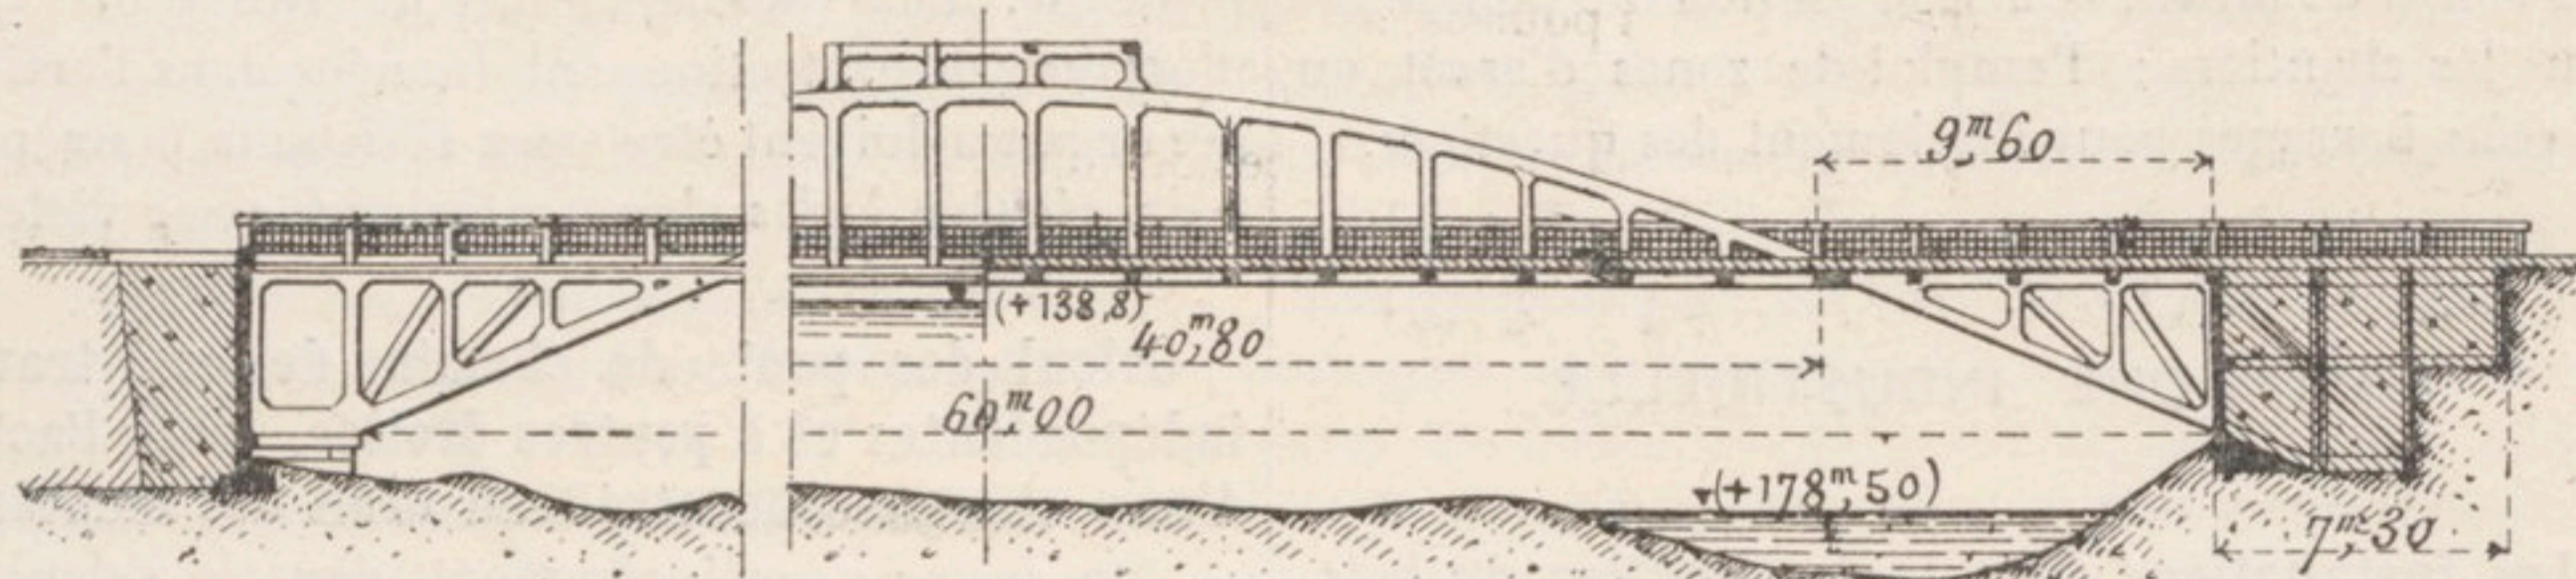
et 2. — Élévation partielle et coupe transversale du pont en béton armé de la Mescla, sur le Var.
